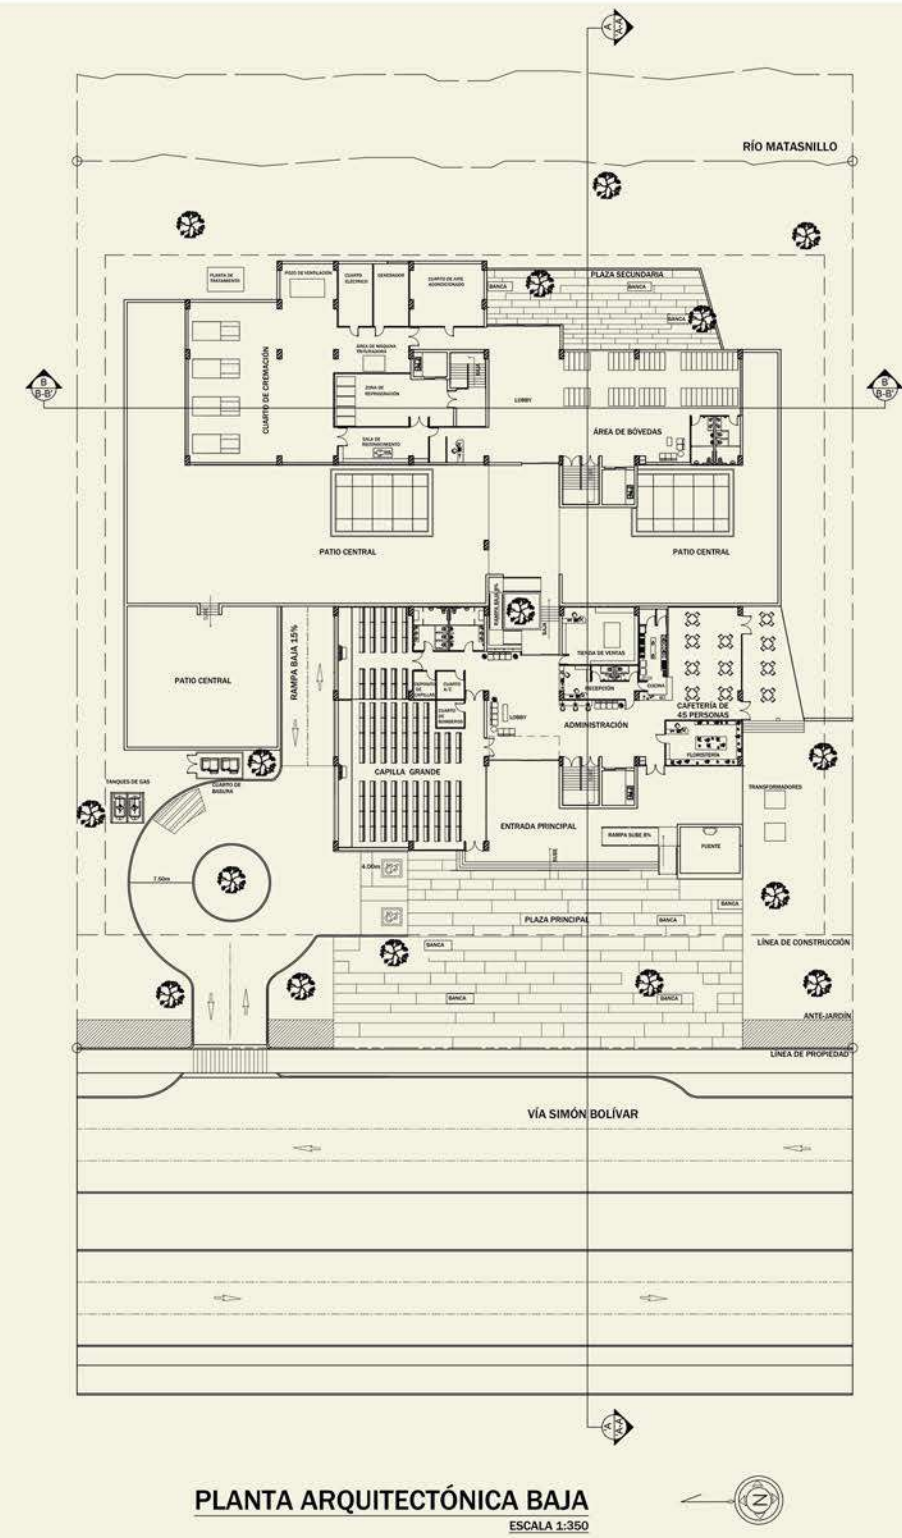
Planta arquitectónica baja. (Escala para plano 2x3)
